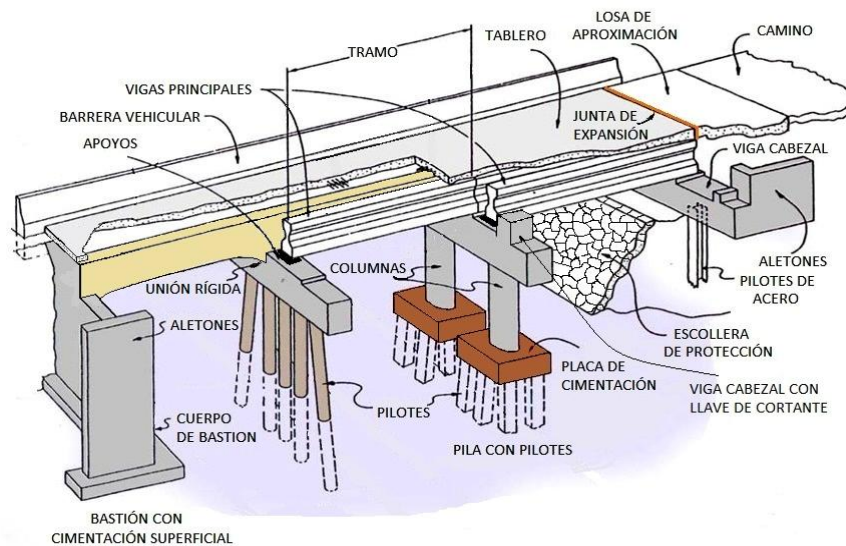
COMPONENTES DE UN PUENTE TÍPICO DE VIGAS DE CONCRETO
